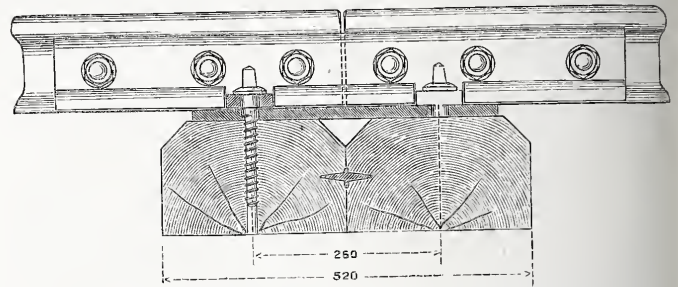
Stoßverbindung auf hölzernen Doppelschwellen.
